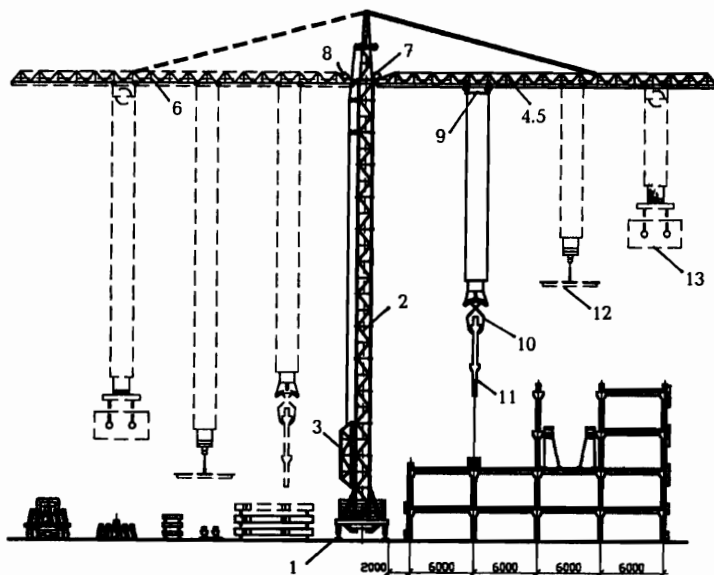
Схема монтажа конструкций многоэтажного здания краноманипулятором: 1 - ходовая часть; 2 - башня; 3 - монтажная стойка; 4, 5 - стрелы; 6 - рабочая противовесная консоль; 7, 8 - кронштейны; 9 - грузовая тележка; 10 - грузозахват; 11, 12, 13 - монтируемые конструкции
